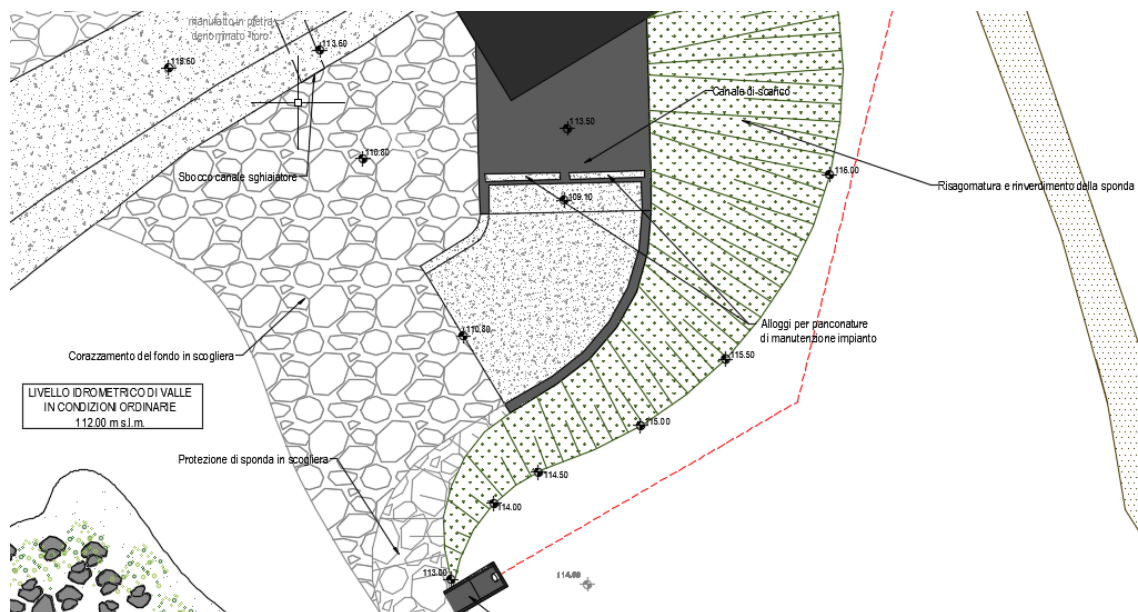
VISTA IN PIANTA DEL CANALE DI SCARICO
